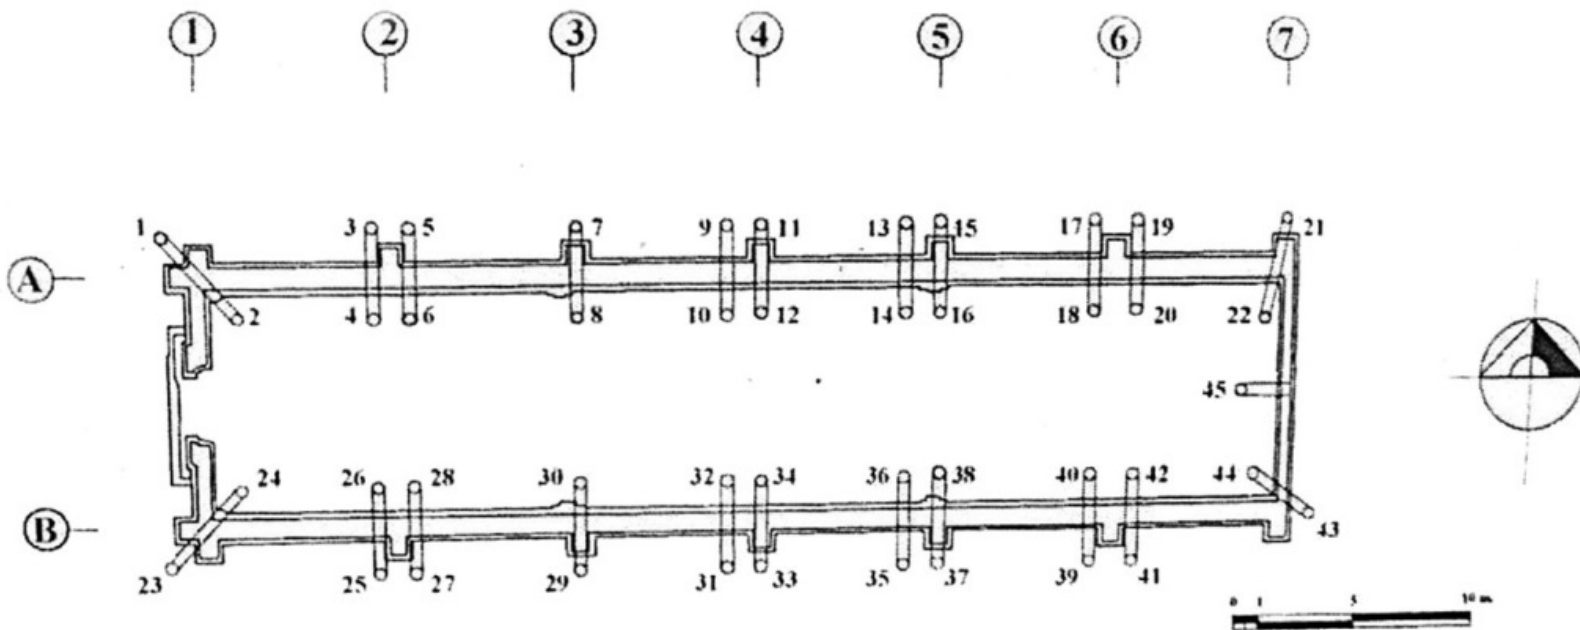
Planta arquitectónica de la Excapilla en palacio Nacional. Ubicación de los pozos excavados. Adaptado de P. O. Corona (2008), México.
